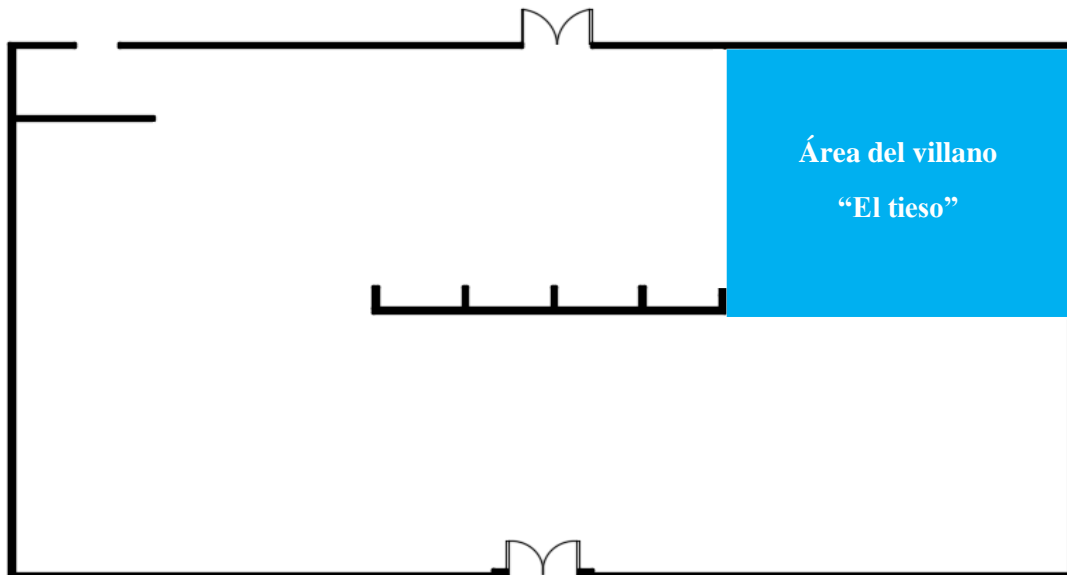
Planta arquitectónica de la galería Carcaño y el área a intervenir. Fuente propia.
